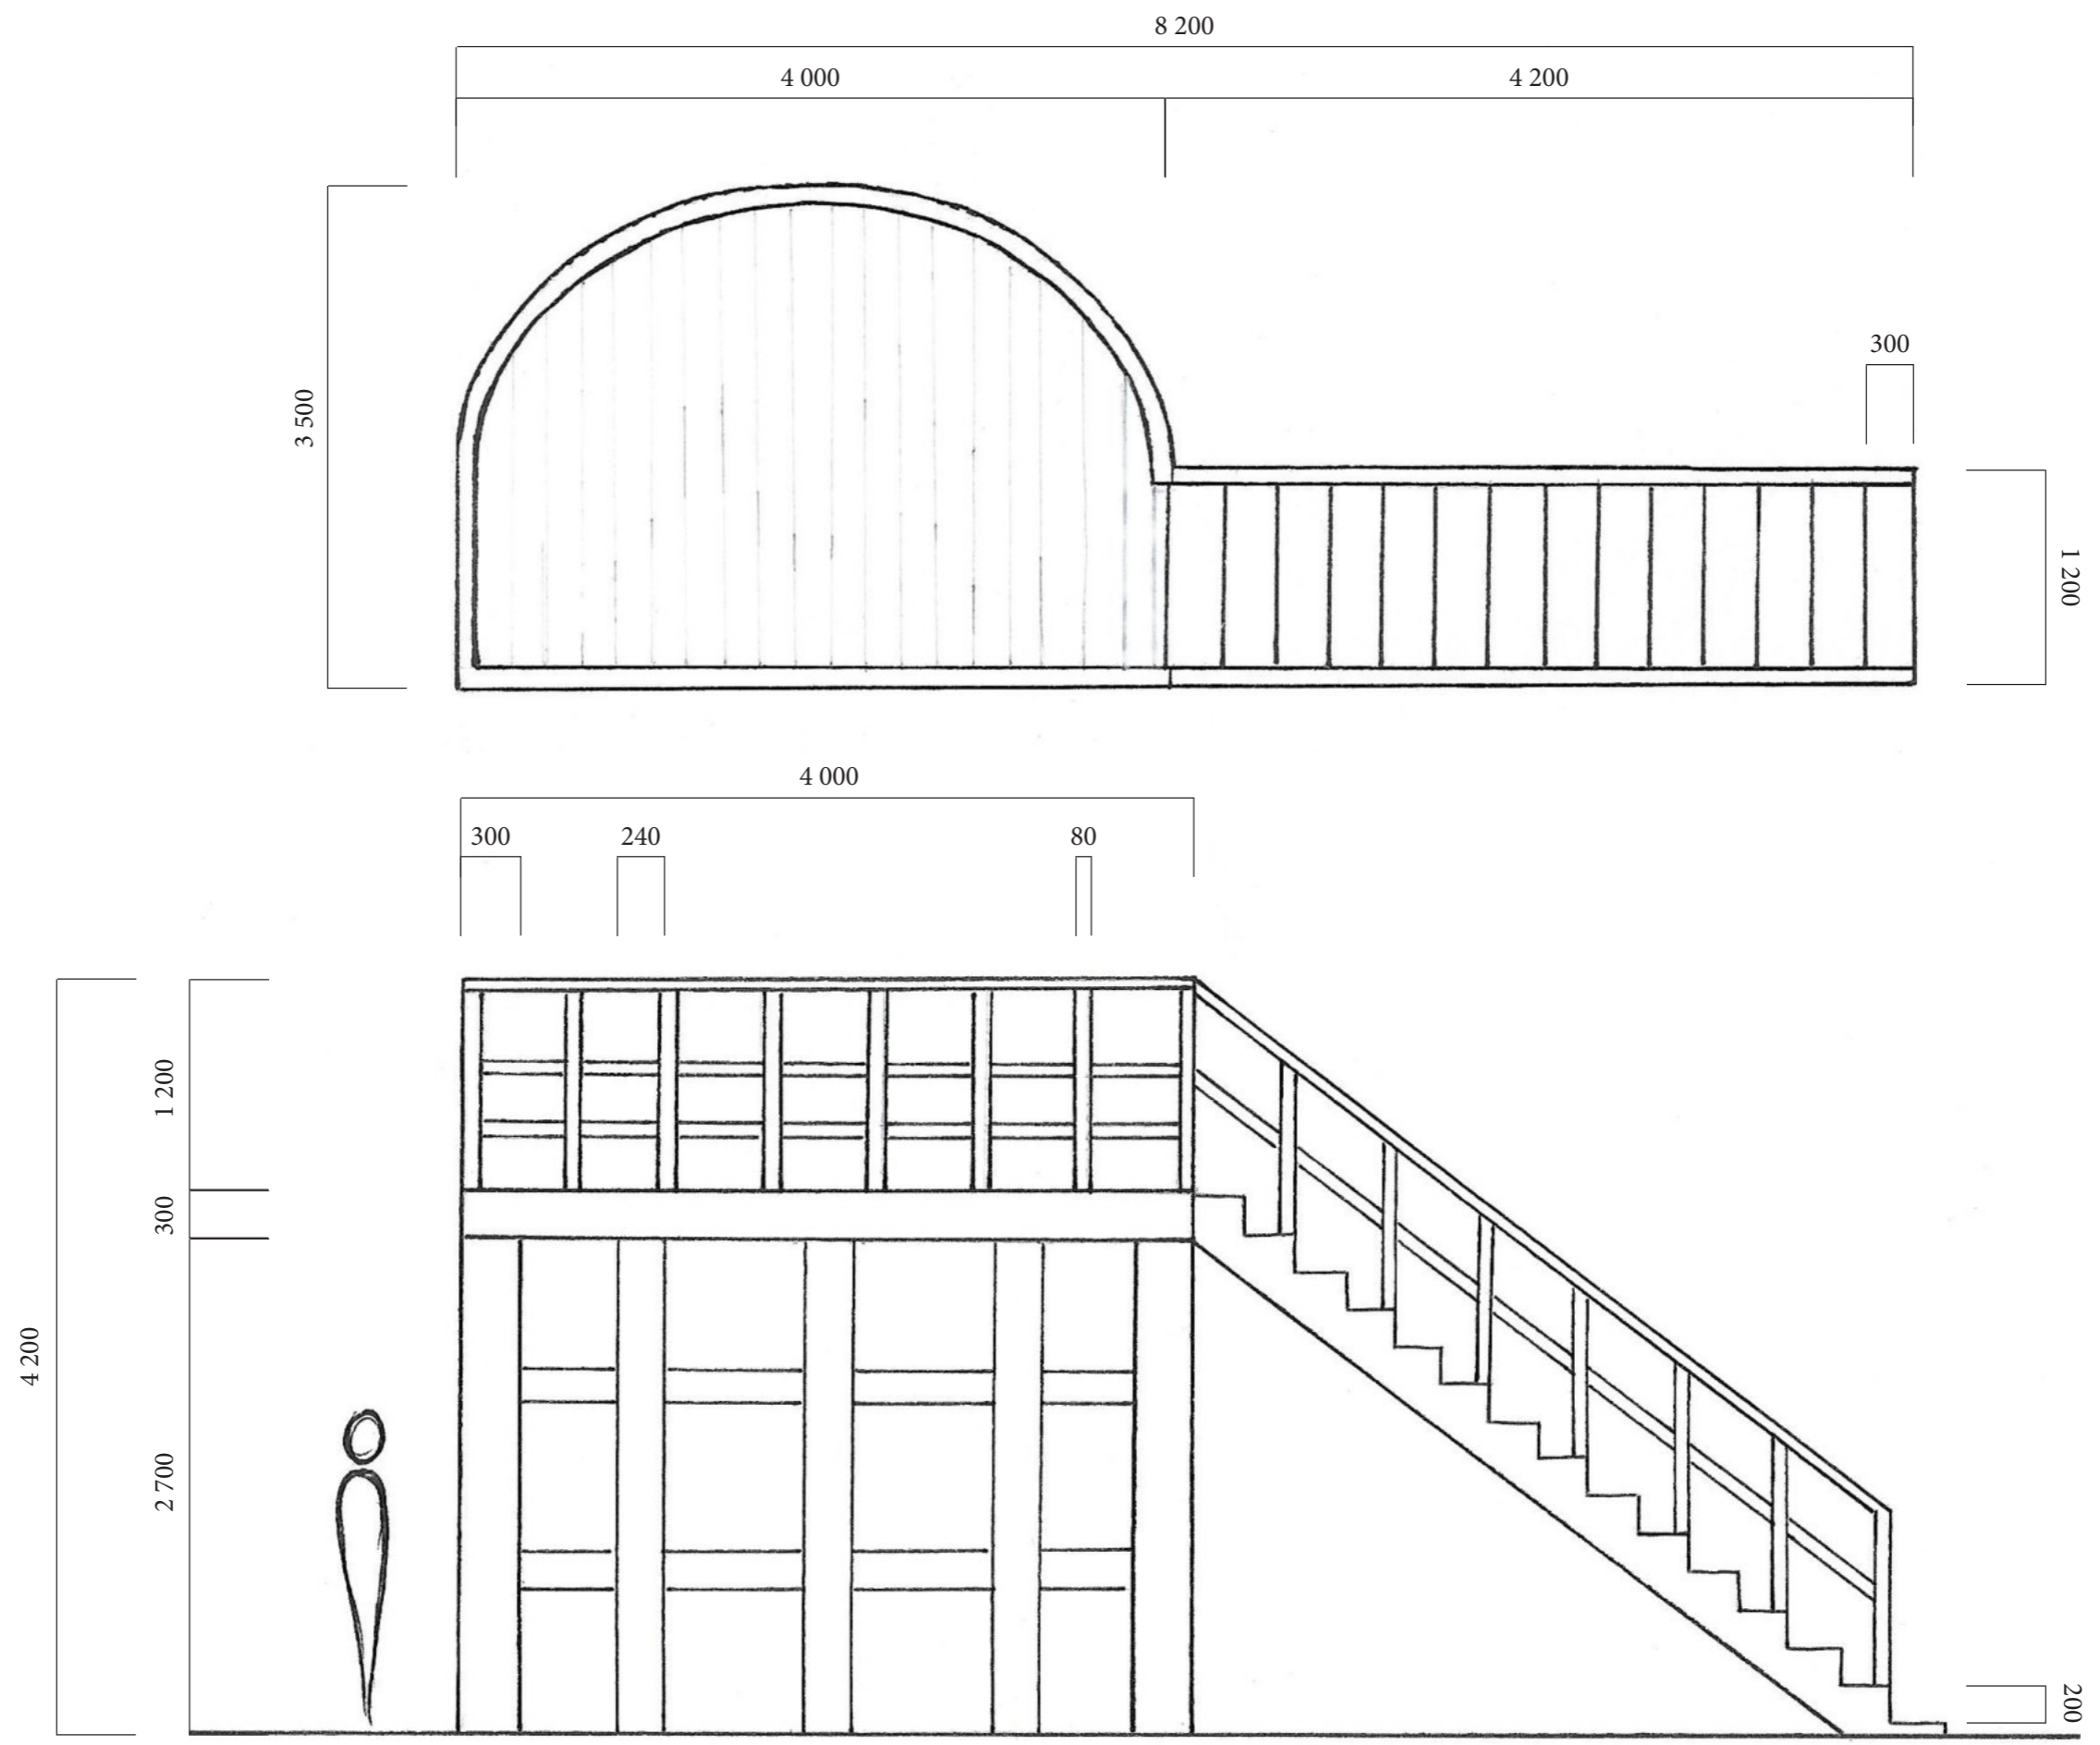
Technický detail - vyhlídka (zdroj: autor práce)
